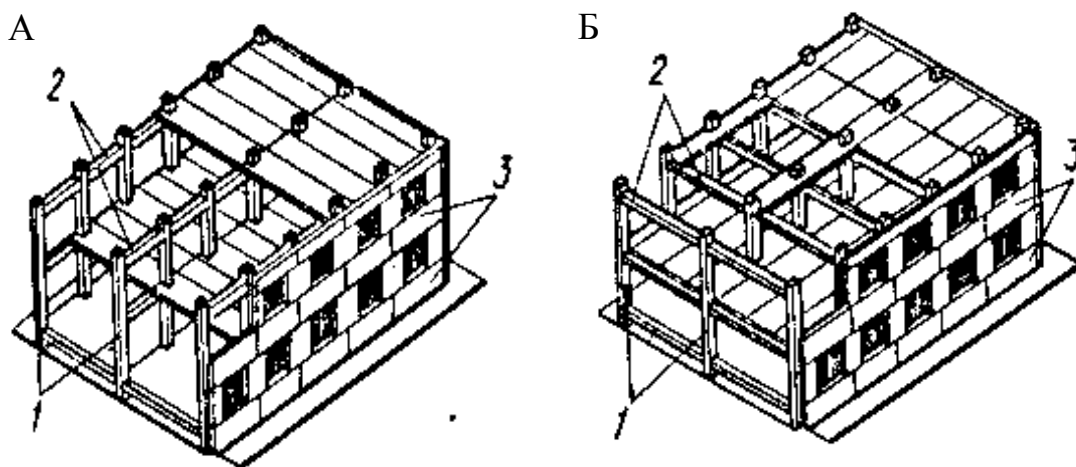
Схемы конструкций зданий с неполным каркасом, А- с продольным расположением ригелей, Б- с поперечным расположением ригелей. 1-колонны, 2-ригели, 3 – панели наружной стены.
